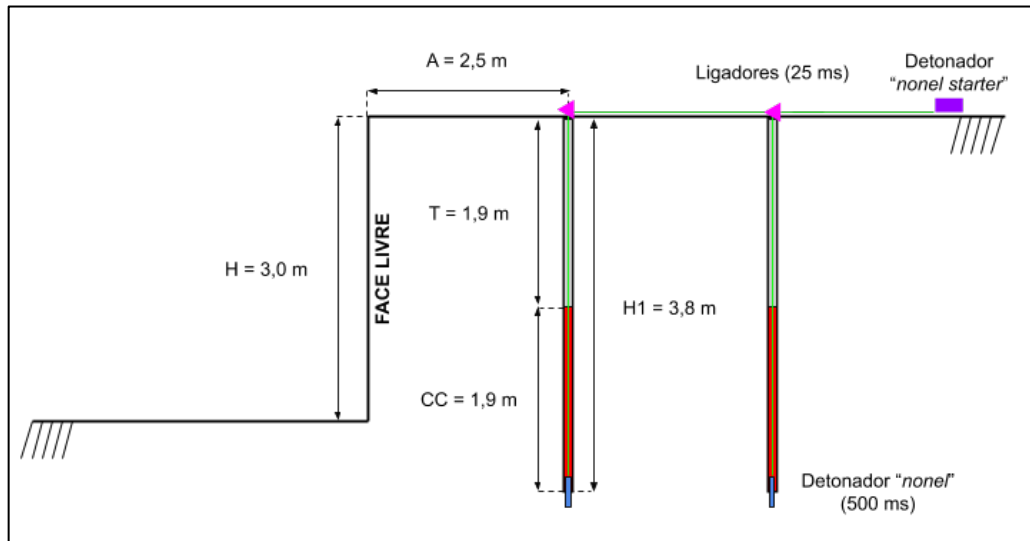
Secção longitudinal do furo da cava “Vendoia” (traduzido de Cardu & Giraudi, 2008)
